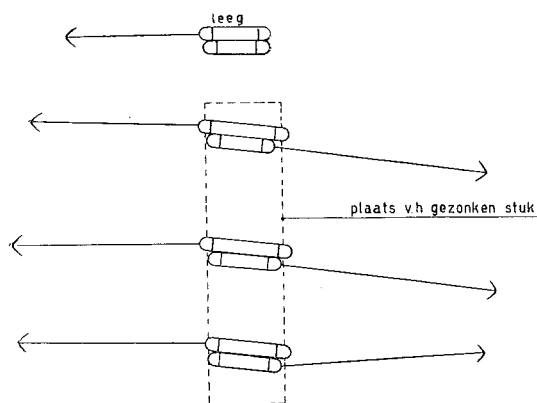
Situatie van de steenbakken boven het gezonken stuk tijdens het steen storten.
